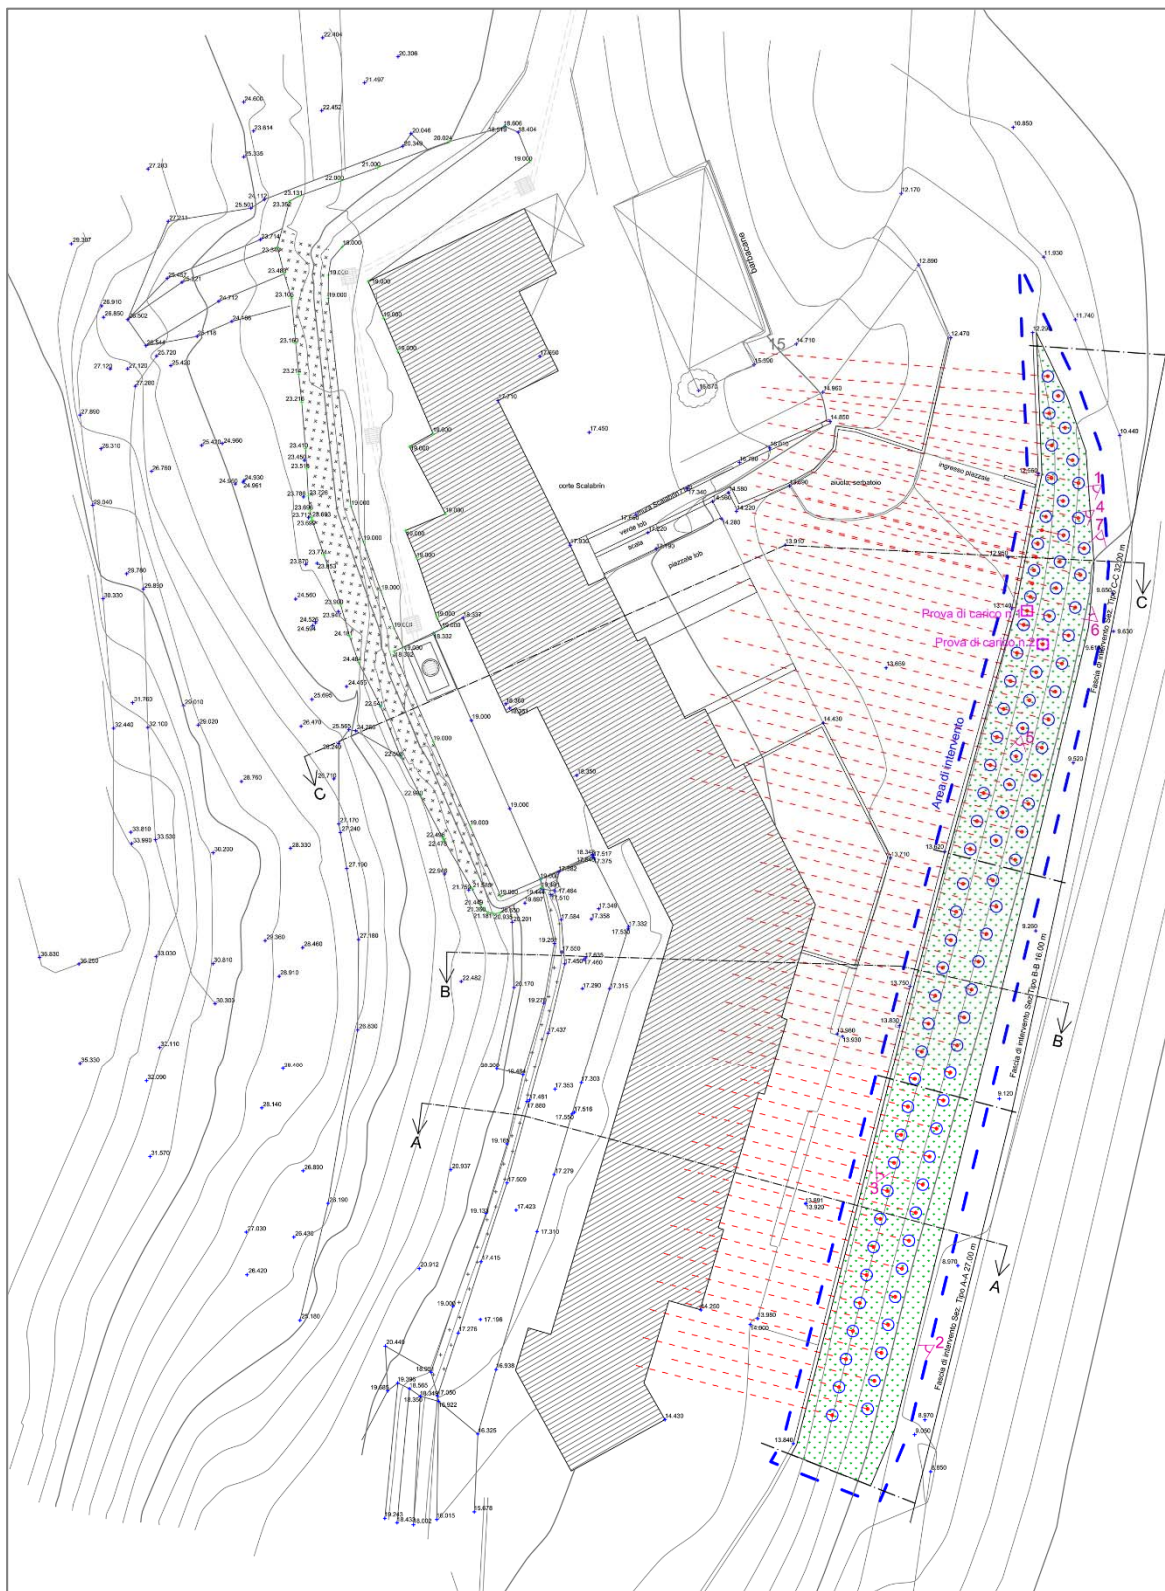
Frana di Via Monte a Cornedo Vicentino (VI): planimetria dell'area e interventi di progetto. Estratto da tavole di progetto, Studio Rech.
